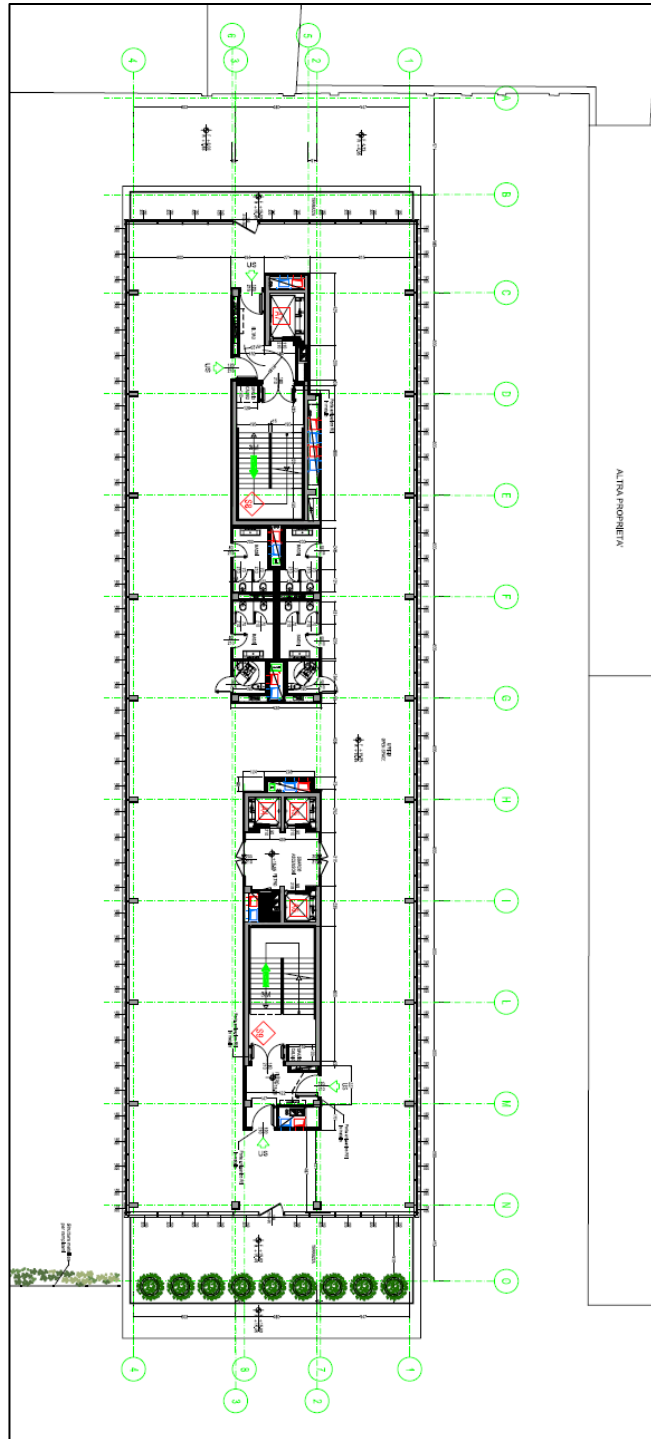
Planimetria tipo (piani primo, secondo e terzo)
